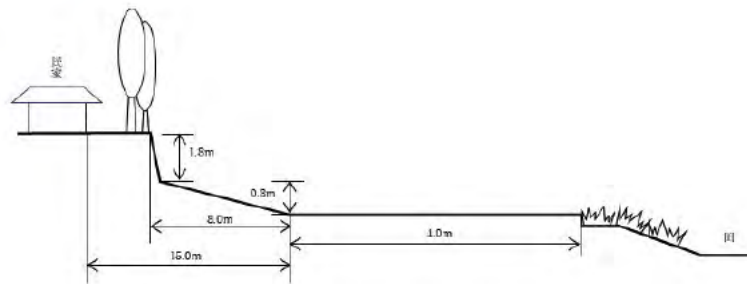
騒音予測地点cの詳細図及び道路断面図
